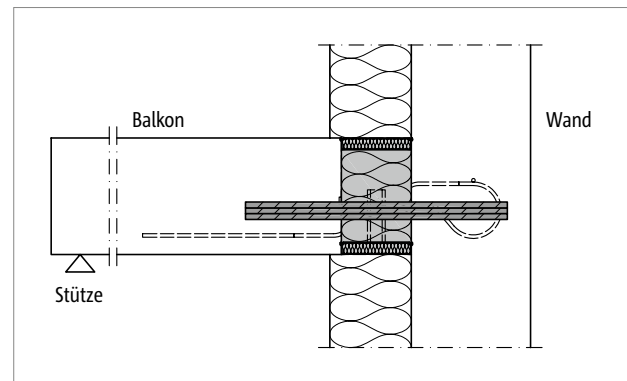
Schöck Isokorb® XT Typ QL, HP-VV-NN: Anschluss an einer Stahlbetonwand mit Außendämmung
